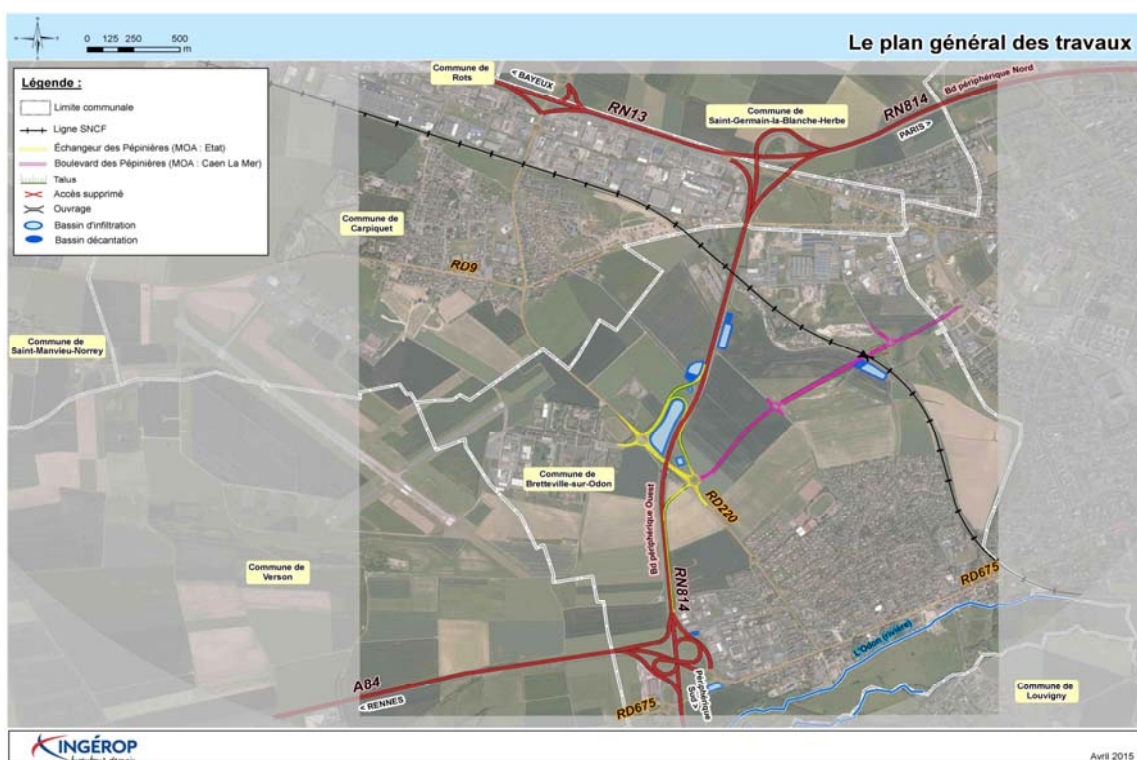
plan général des travaux (dans l'étude d'impact) (boulevard des Pépinières en fuschia, échangeur en jaune, bassins en bleu)
